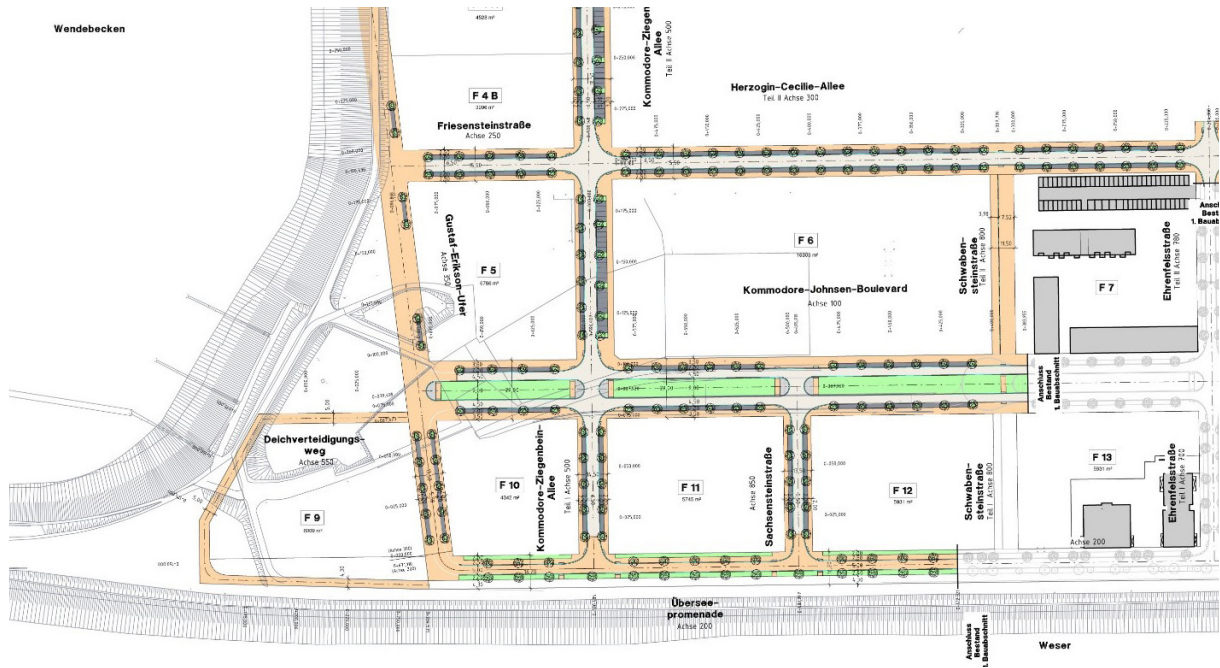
Lageplan Verkehrsanlagen WFB Stand 31.01.2014
